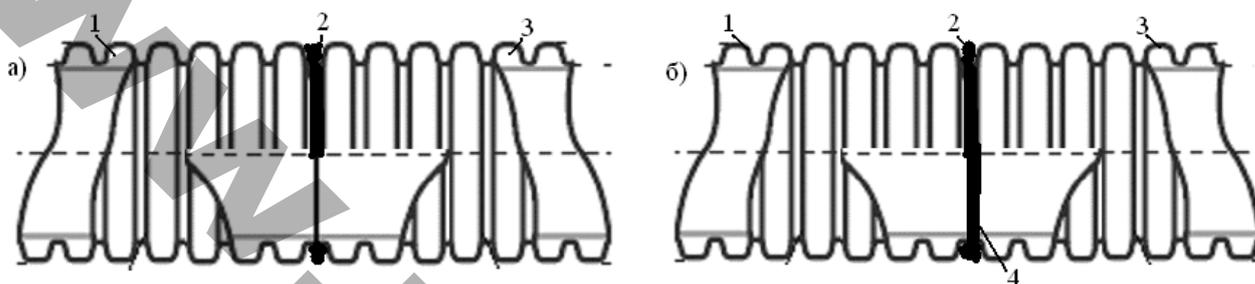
Соединения ПТ2См (ПТ2Сг) между собой экструзионной сваркой со сварными швами:
